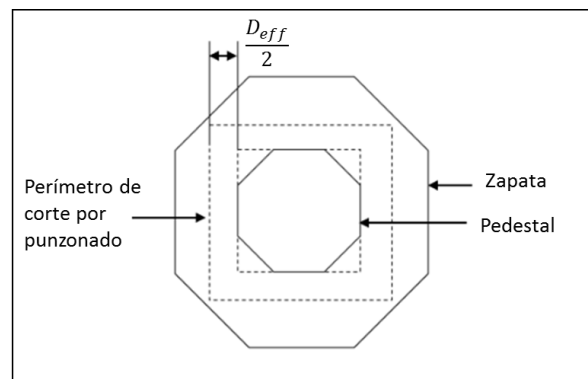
Vista de planta de la fundación. Fuente: STAAD Foundation Advanced.
